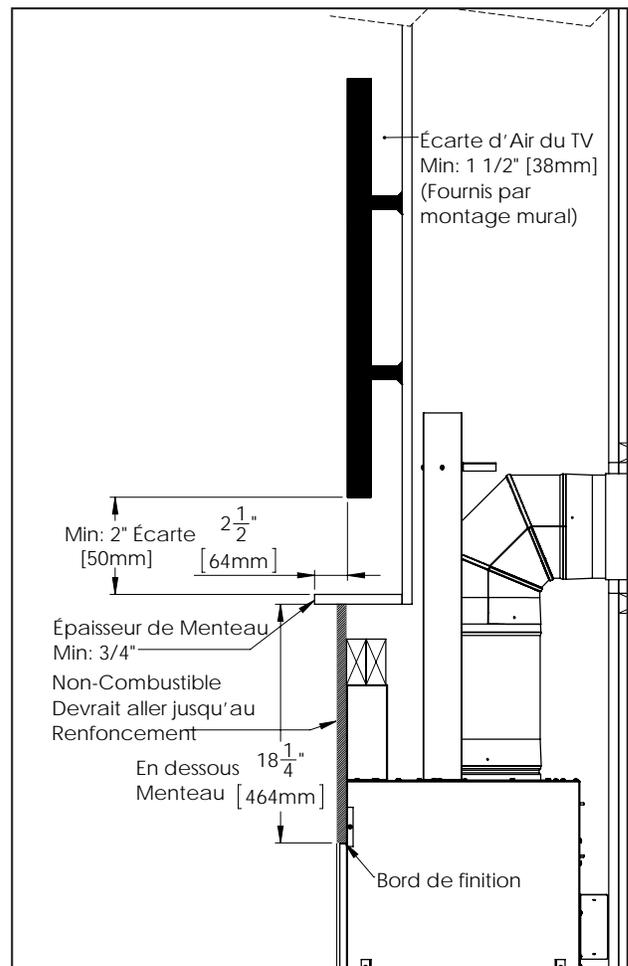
Espaces libres minimum pour l'installation du téléviseur dans un renforcement
